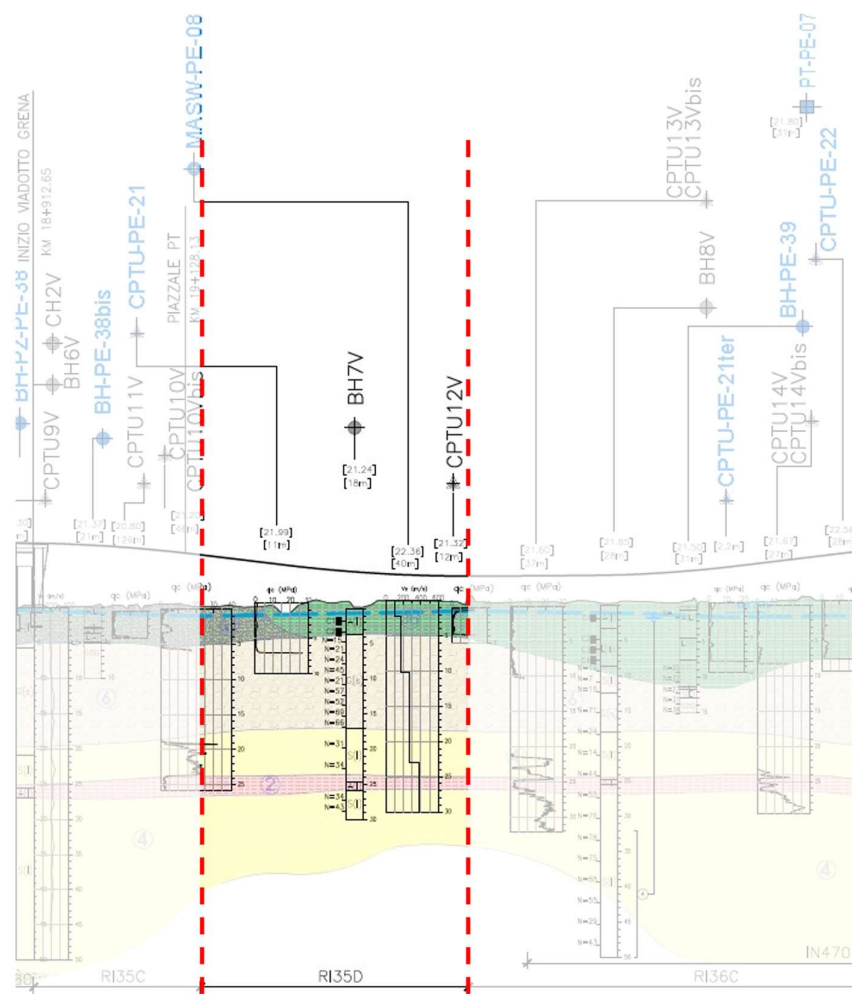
Profilo Geotecnico Rilevato RI35D, estratto dal Profilo Geotecnico Generale (Doc. Rif. [4])
